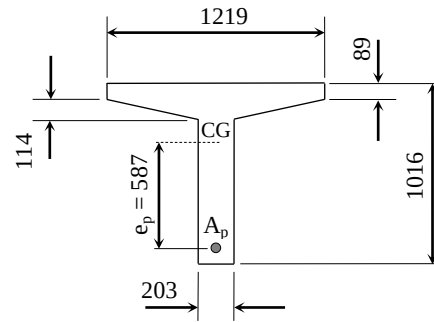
Dimensões (mm) da seção transversal da viga T.
